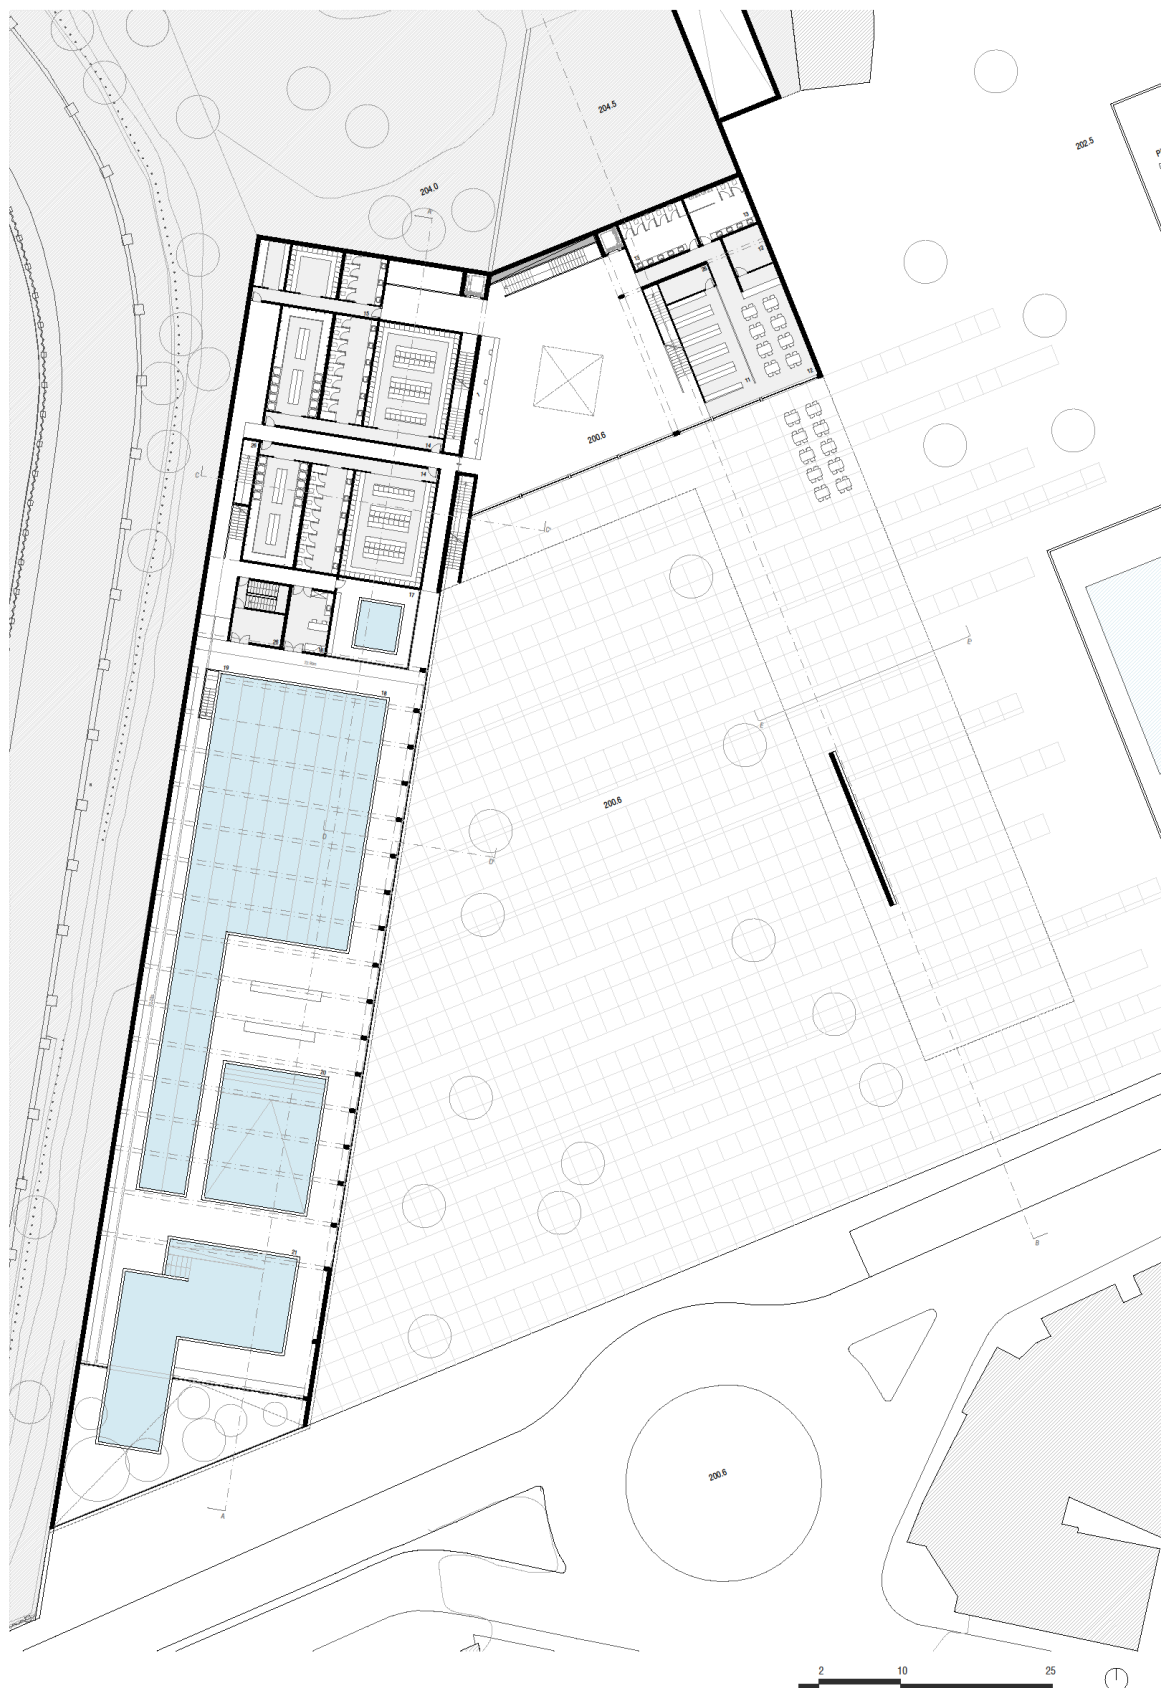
Proposta: Planta Piso 0, Fonte: Autor
